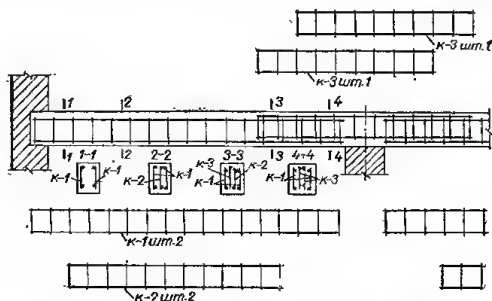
Схема армирования отдельных многопролетных балок (сетки, охватывающие скатую арматуру, не показаны).
